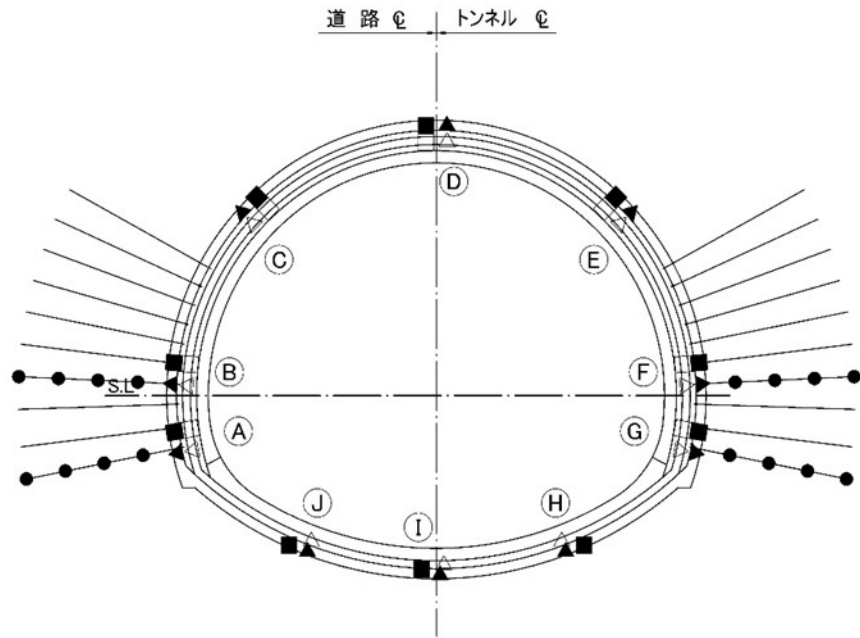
音中トンネル 計測 B 断面図 (P=8,574)
